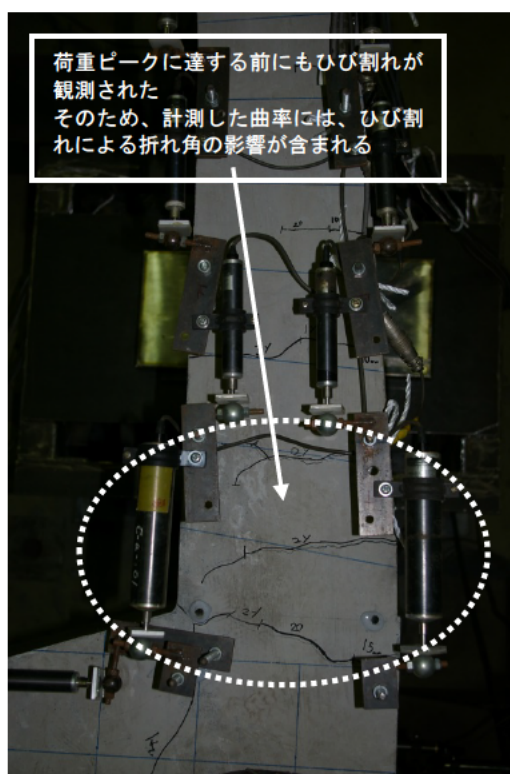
側壁基部の曲率計測範囲内に発生したひび割れ
